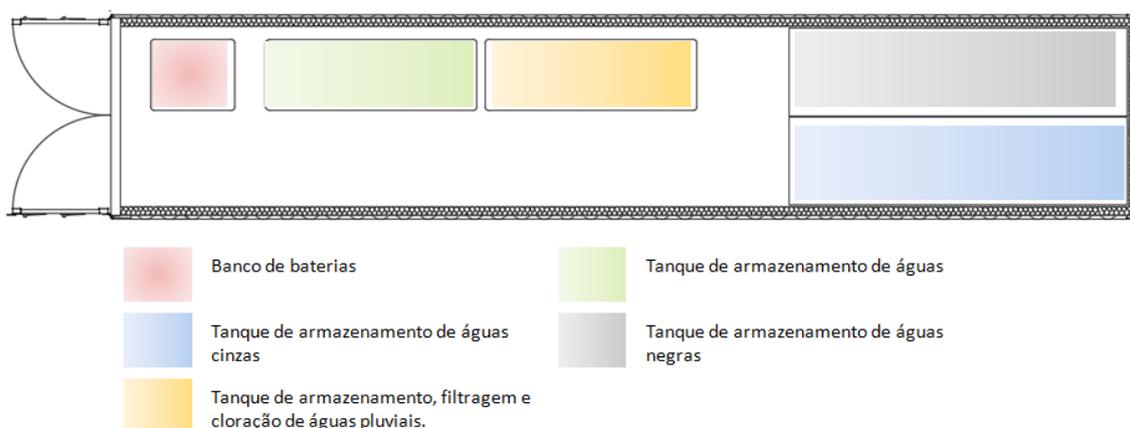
Planta Baixa Módulo 04 - Compartimento Técnico 40 pés. Fonte: elaborado pelos autores.
